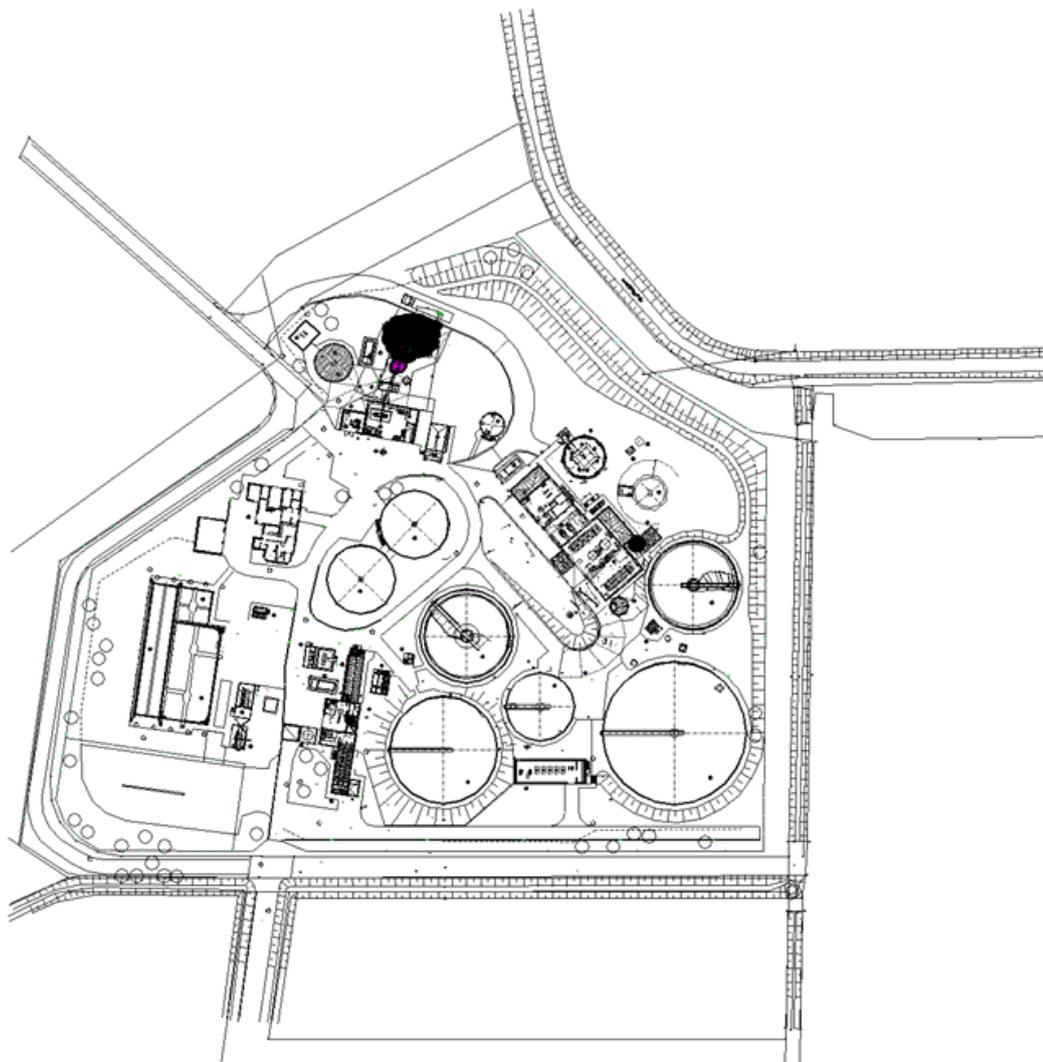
Übersichtslageplan Kläranlage Mettingen
